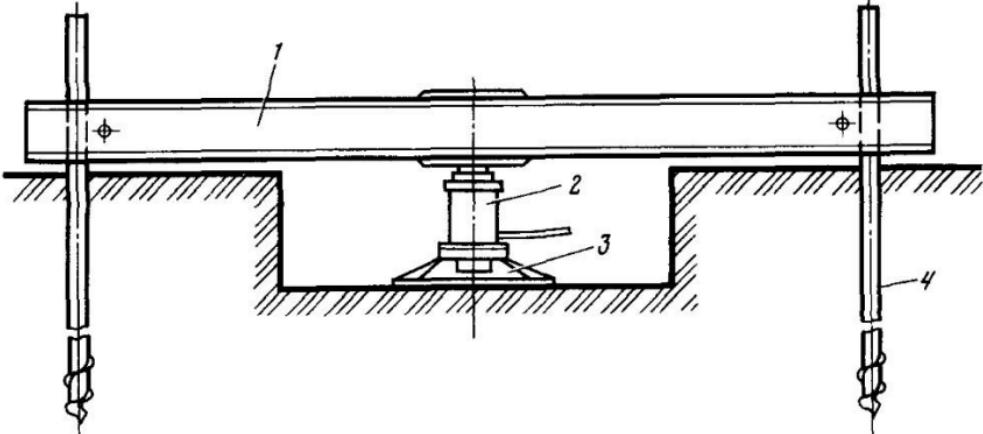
Схема установки для испытания грунтов в шурфе статической нагрузкой:
